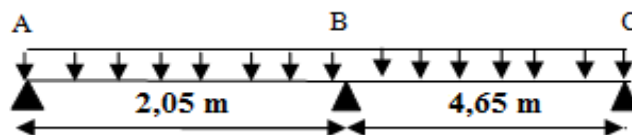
Schéma statique de la poutrelle T2 (plancher terrasse inaccessible)
